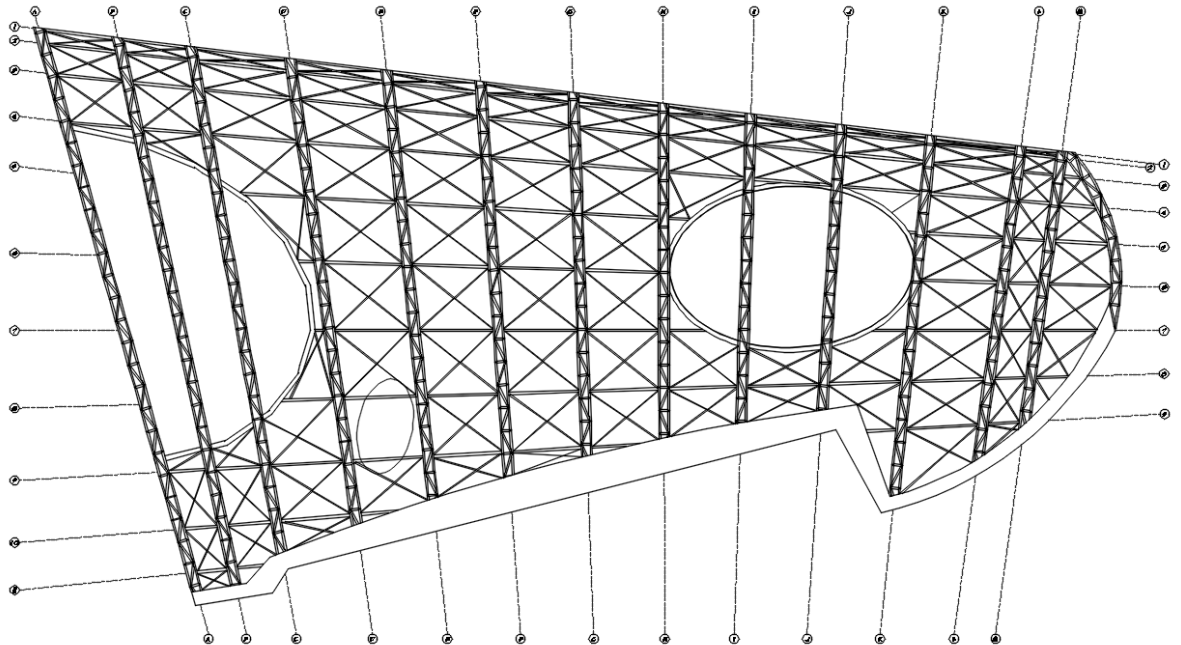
PLANO DE CIMENTACIONES Y PROYECCIÓN DE CERCHAS
